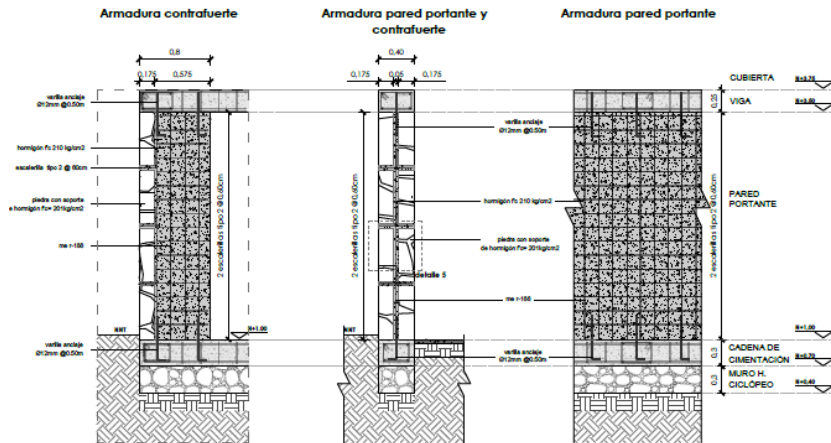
Armadura de la pared y contrafuertes Fuente: Cristian Campaña, 2018
